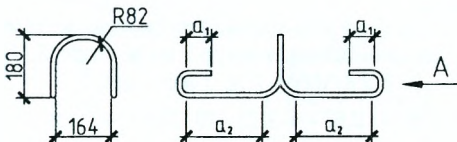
Монтажные петли П4 сборной железобетонной многолустной плиты
